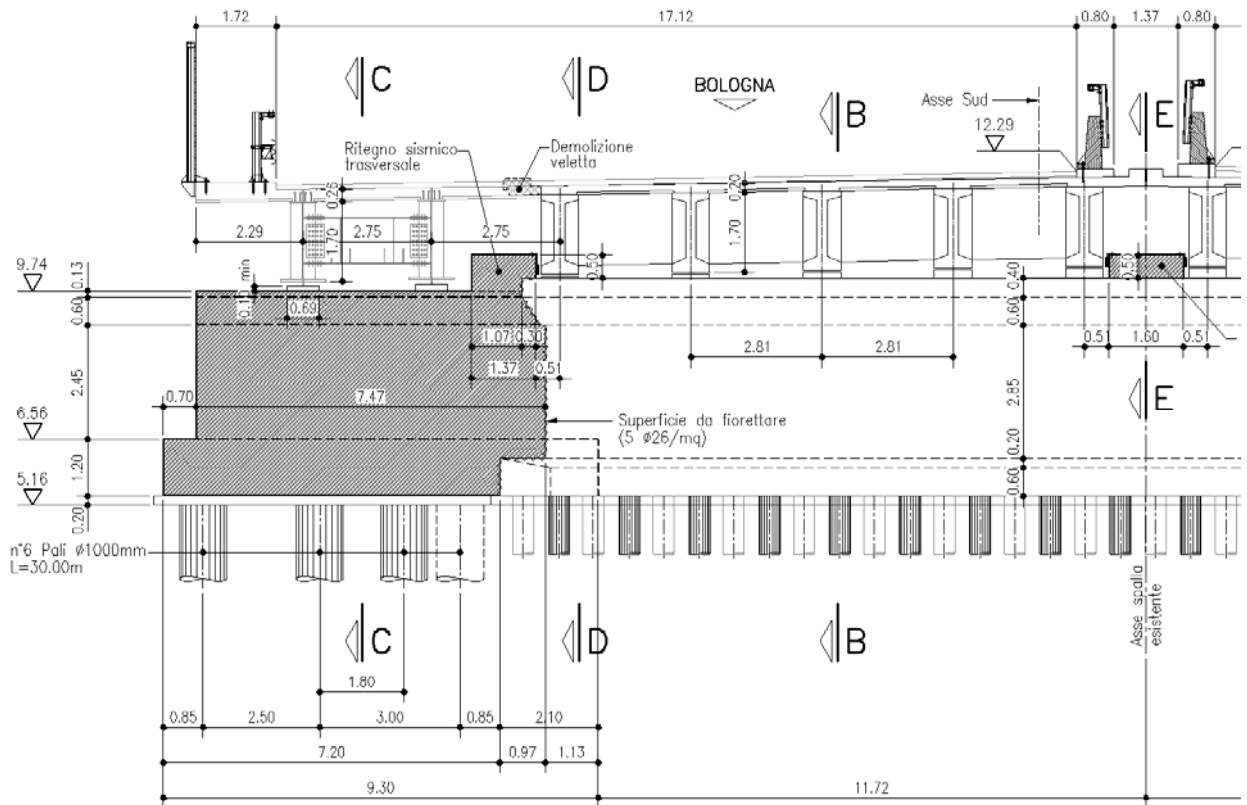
Semi-prospetto pila esistente ed in ampliamento
